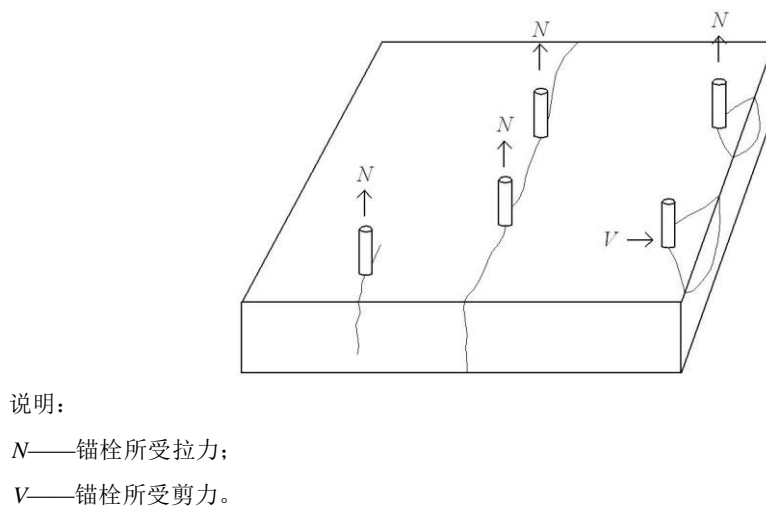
混凝土劈裂破坏和混凝土边缘破坏
